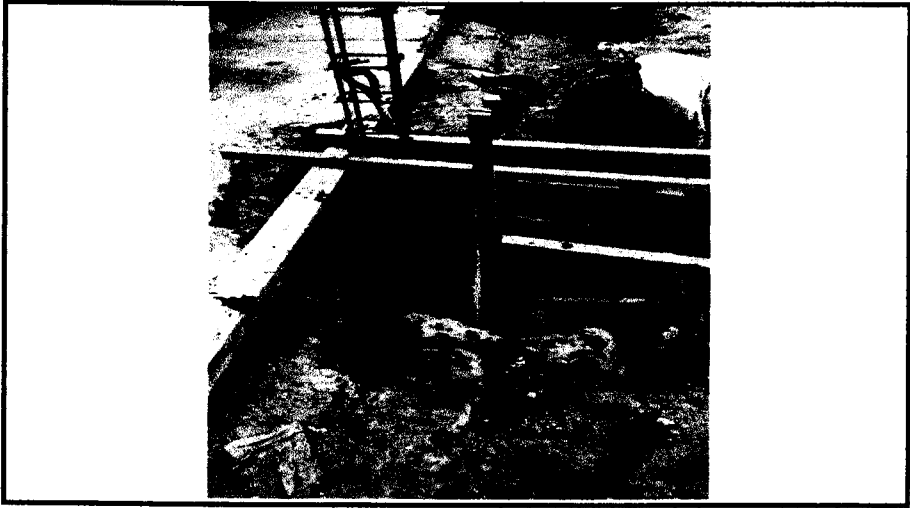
VACIADO DE CONCRETO FC 210KG/CM2 EN ZAPATAS TRAMO 1
